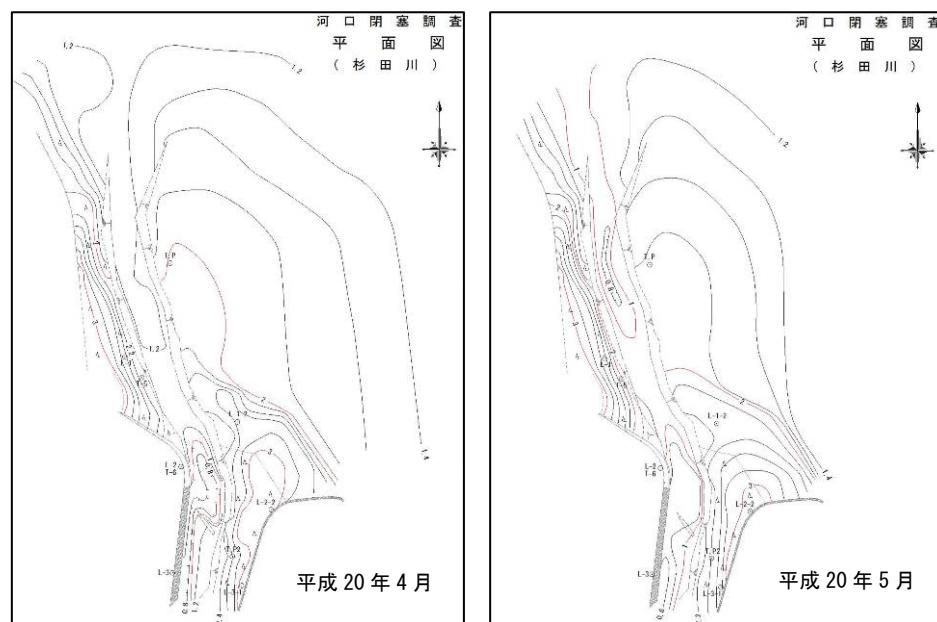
6. 1. 44(1) 杉田川河口部の平面図
